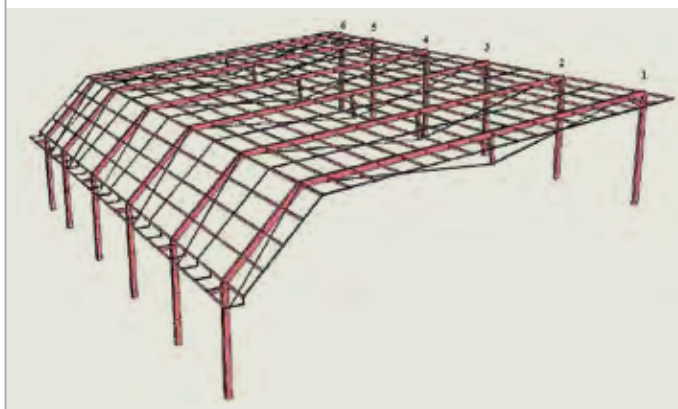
Perspectiva esquemática da cobertura Terrasse Jardim (Fonte: arquivo Projectação)
